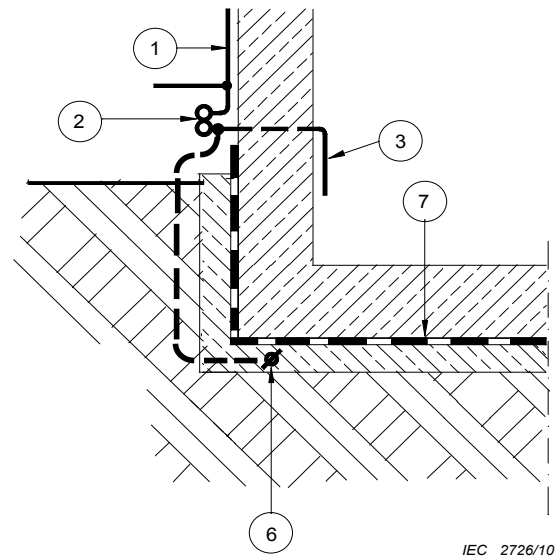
Fondation isolée avec conducteur de terre partiellement dans le sol
